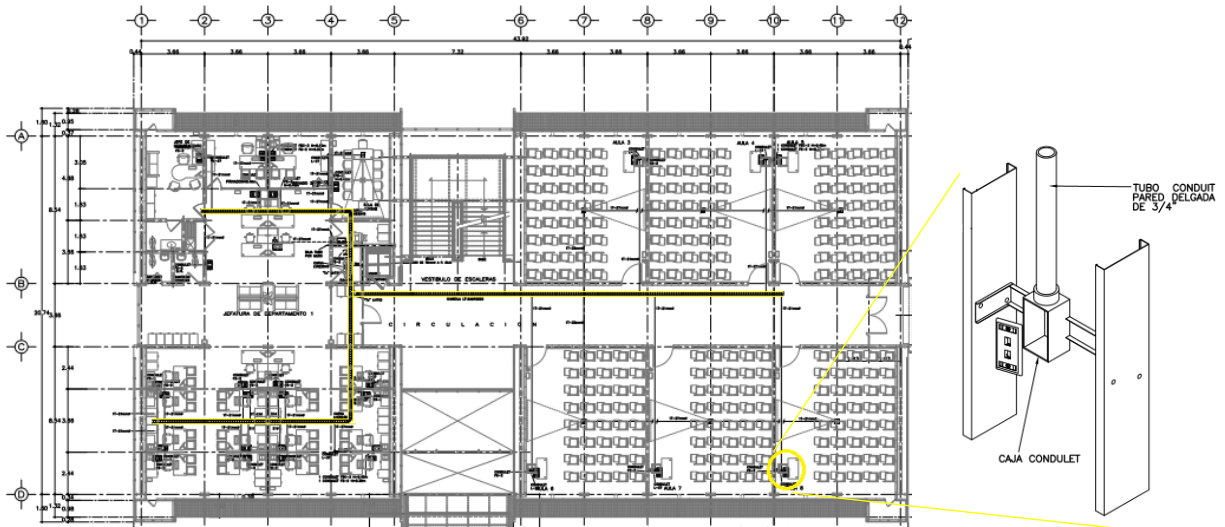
Red de voz y datos en planta baja y detalle de accesorios
